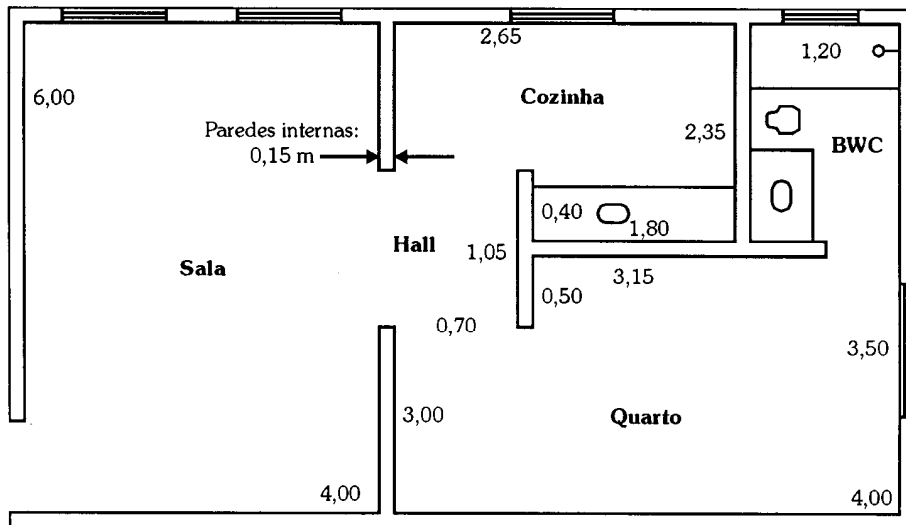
Planta Baixa de um Pequeno Apartamento
